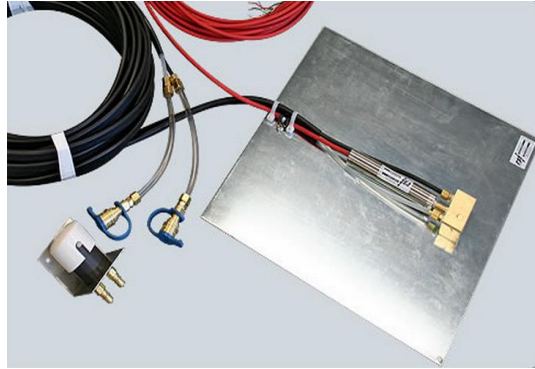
Celda de asentamiento. Fuente: <https://www.rstinstruments.com/>
